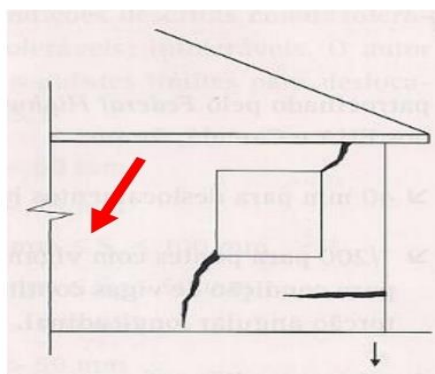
Rachaduras transversais. (Fonte: Milititsky, 2015)
